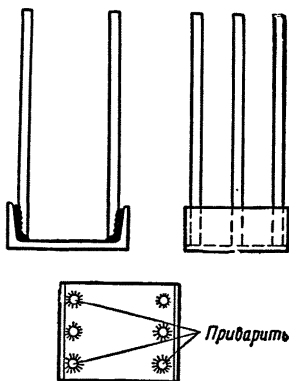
Анкерование ненапрягаемых поперечных стержней путем приварки их к стальным закладным деталям
